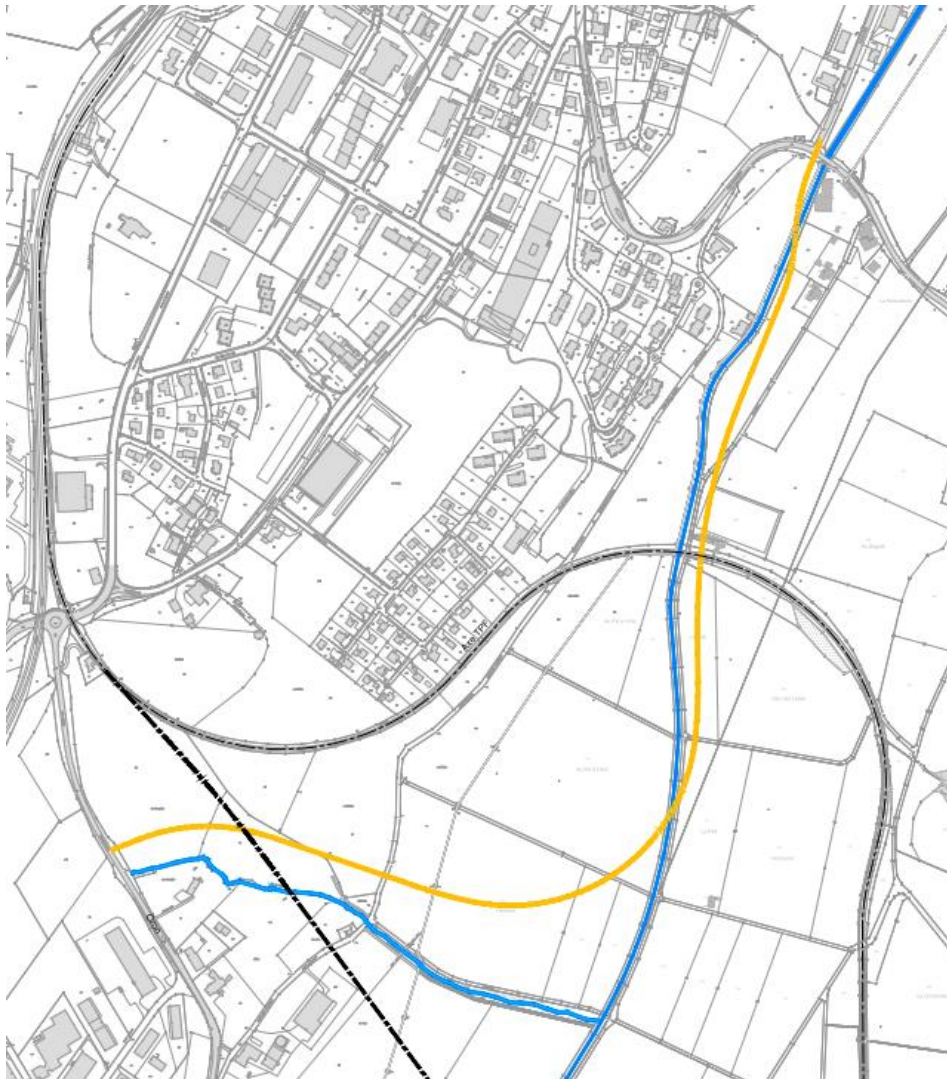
Plan du tronçon Sud Variante 1 - Route de la Parqueterie à Route de Lausanne
